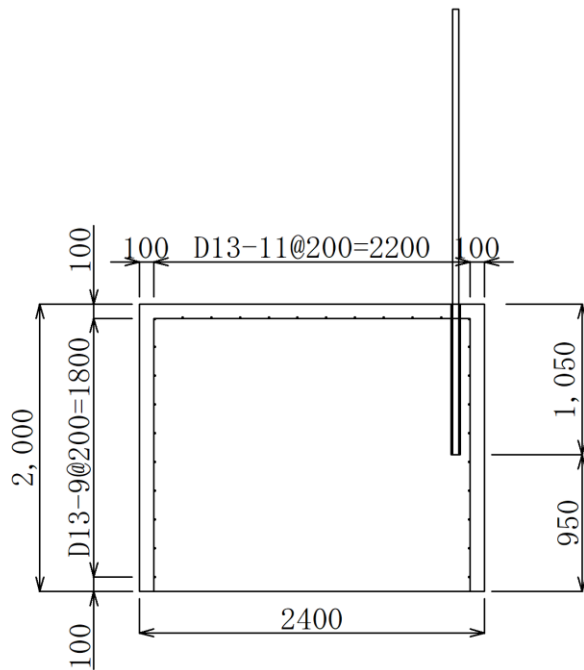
(6) 実験体②の配筋図 (A-A断面図)
